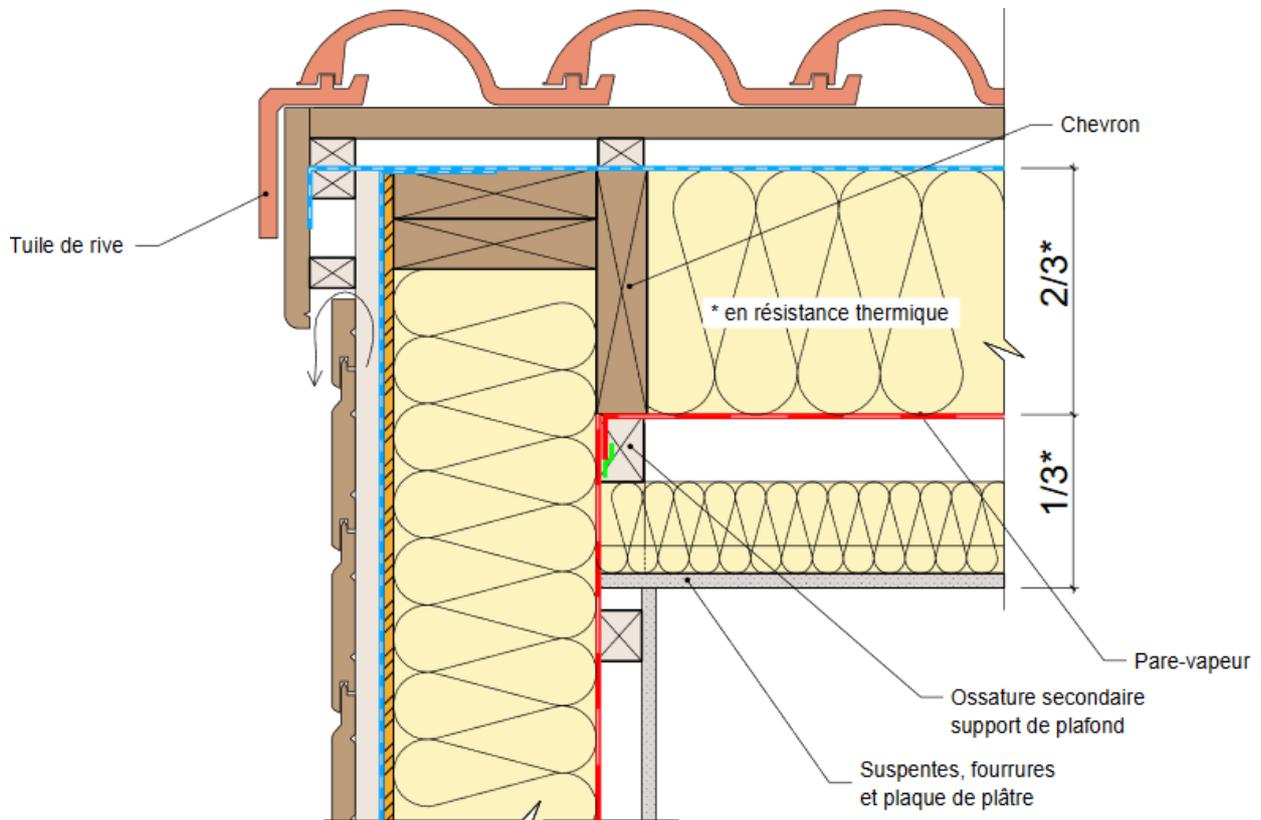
Exemple de liaison entre une toiture et un mur pignon à ossature bois sans dépassée de toiture (coupe verticale)
